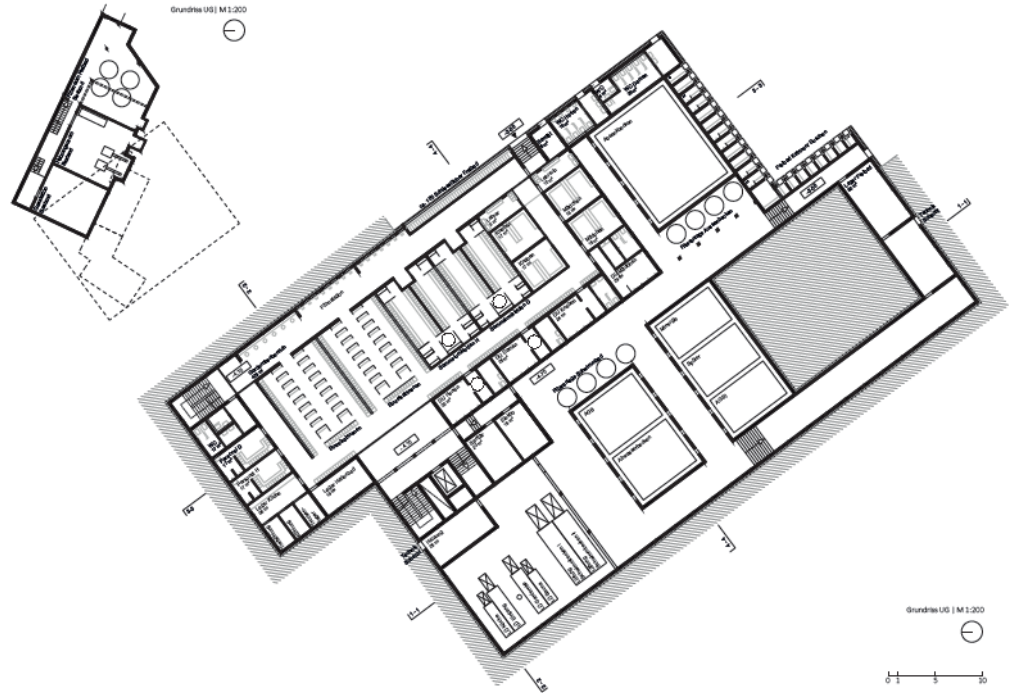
Grundriss Untergeschoss (ohne Massstab)
